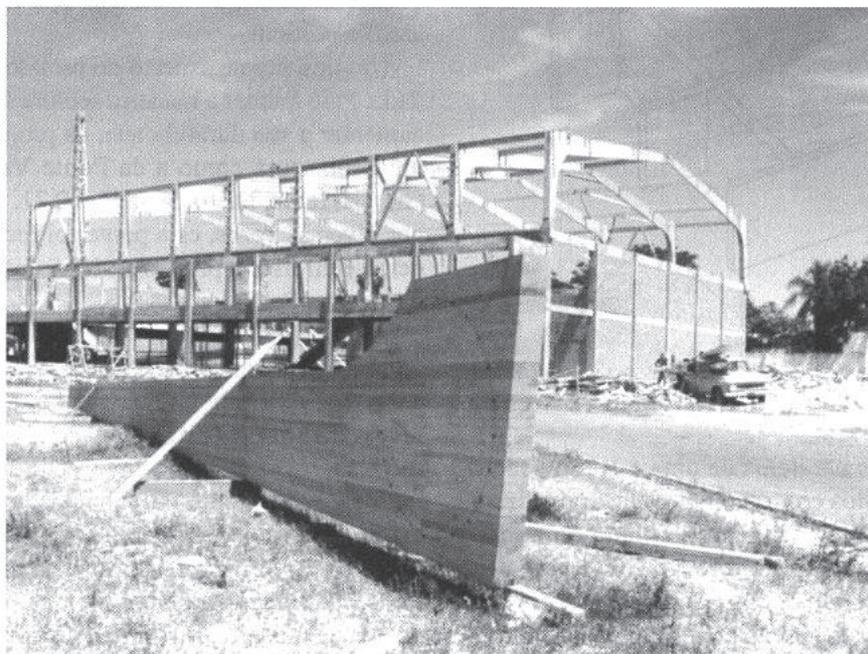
Pórtico de hastes retas em madeira laminada e colada. Em primeiro plano, uma peça a ser montada.
